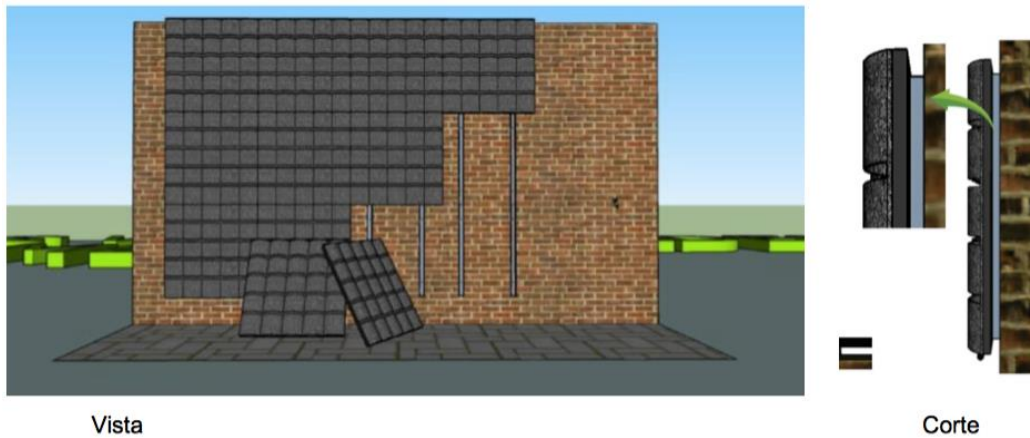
exemplo de fixação dos painéis em vista e corte. (www.greenwall.com.br)
